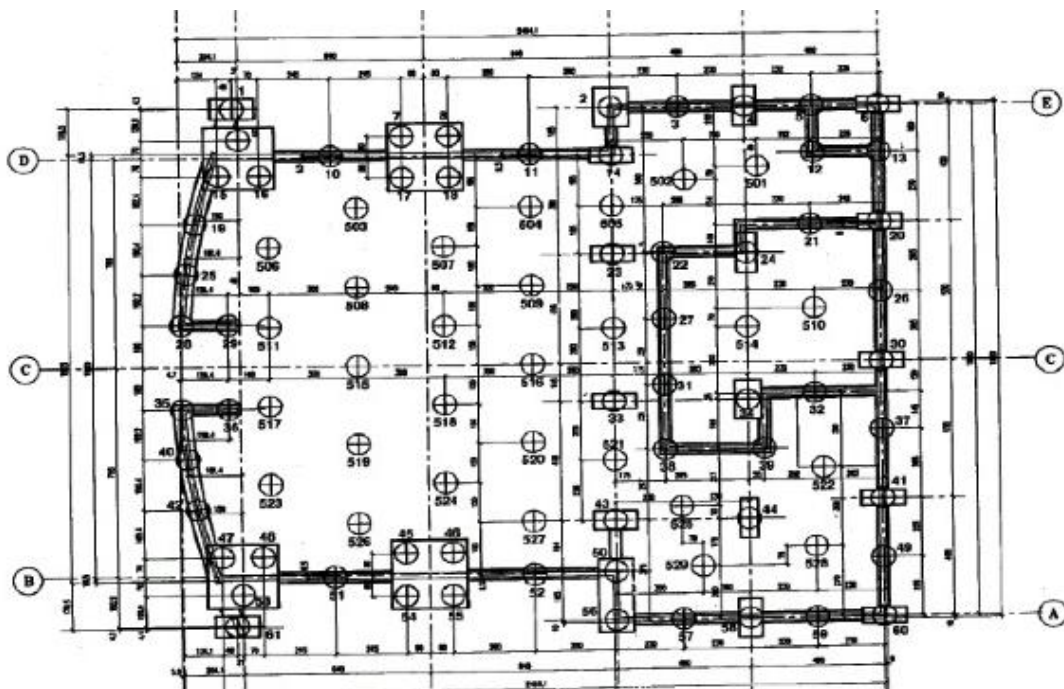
Tipología de solución con tratamiento bajo contrapiso y bajo bases.
